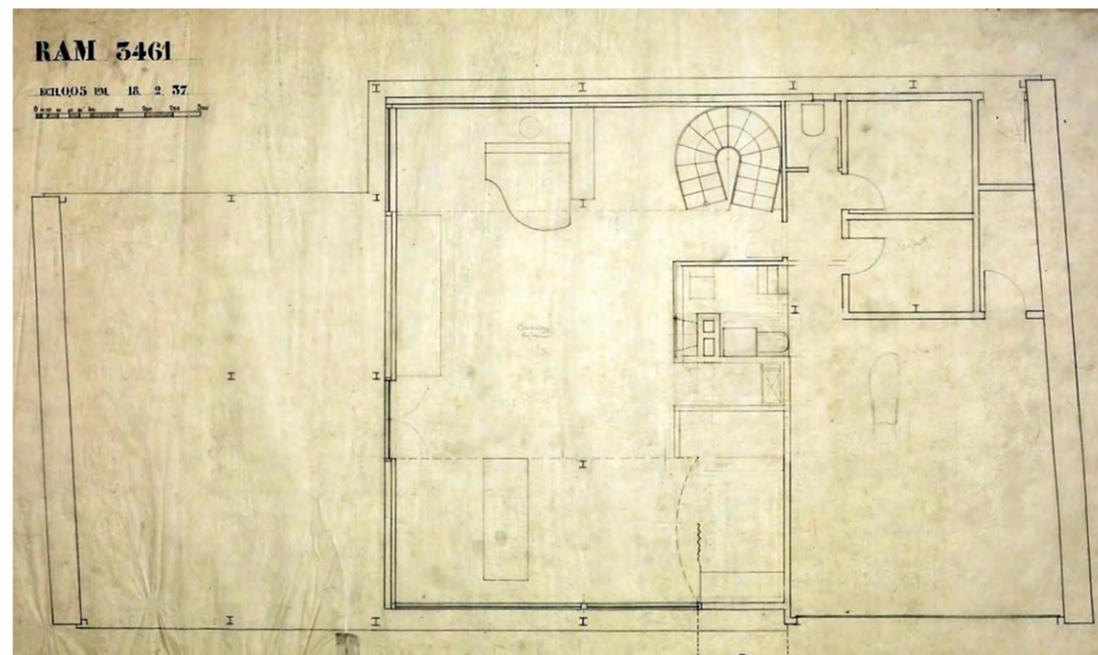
FLC 18556: Vivienda para el doctor Rameaux. Primer proyecto. Planta baja.
